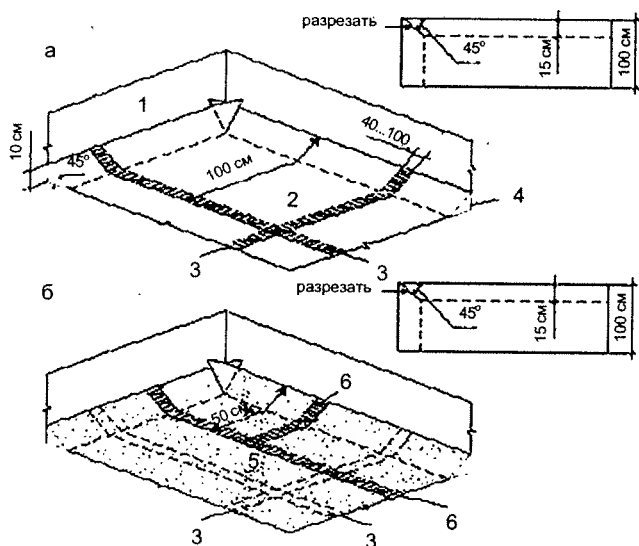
Раскладка и раскрой полотнищ наплавляемого рулонного материала при устройстве основного кровельного ковра в углу парапета:
